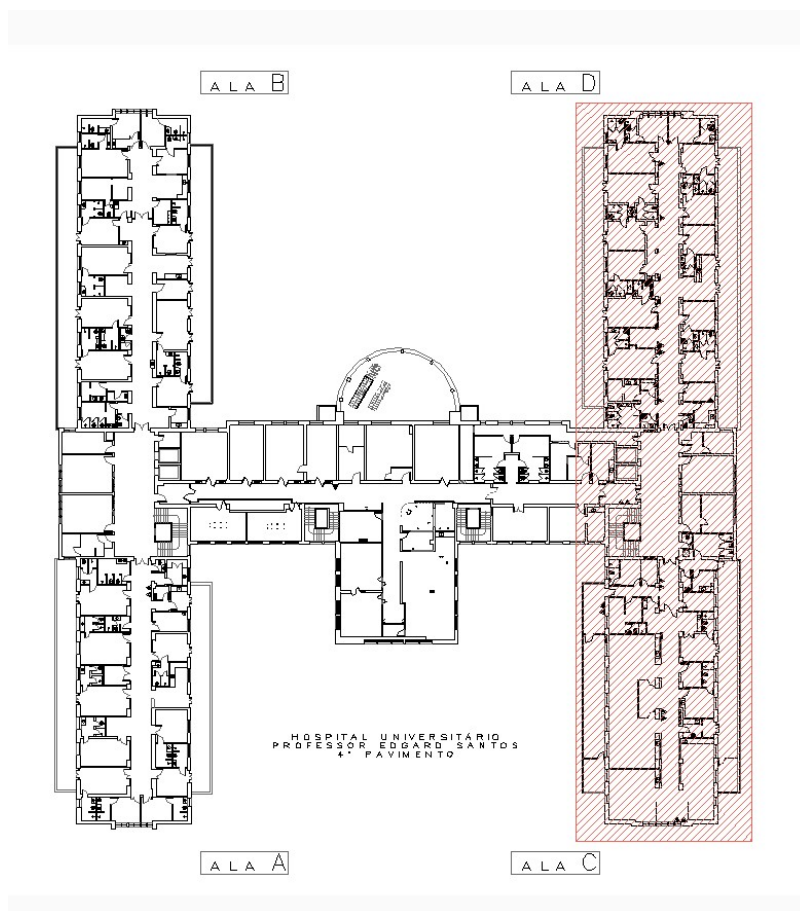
Local de intervenção, no 4º pavimento do Hupes.
